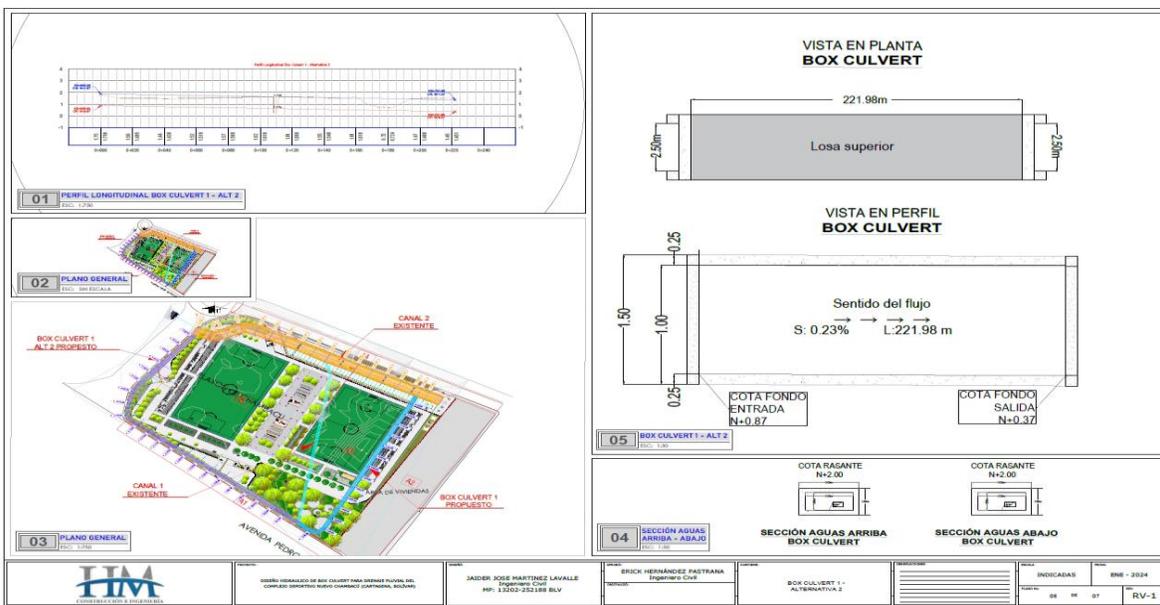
Planos y dimensiones de diseño de Box culvert 1 – Alternativa 2.
